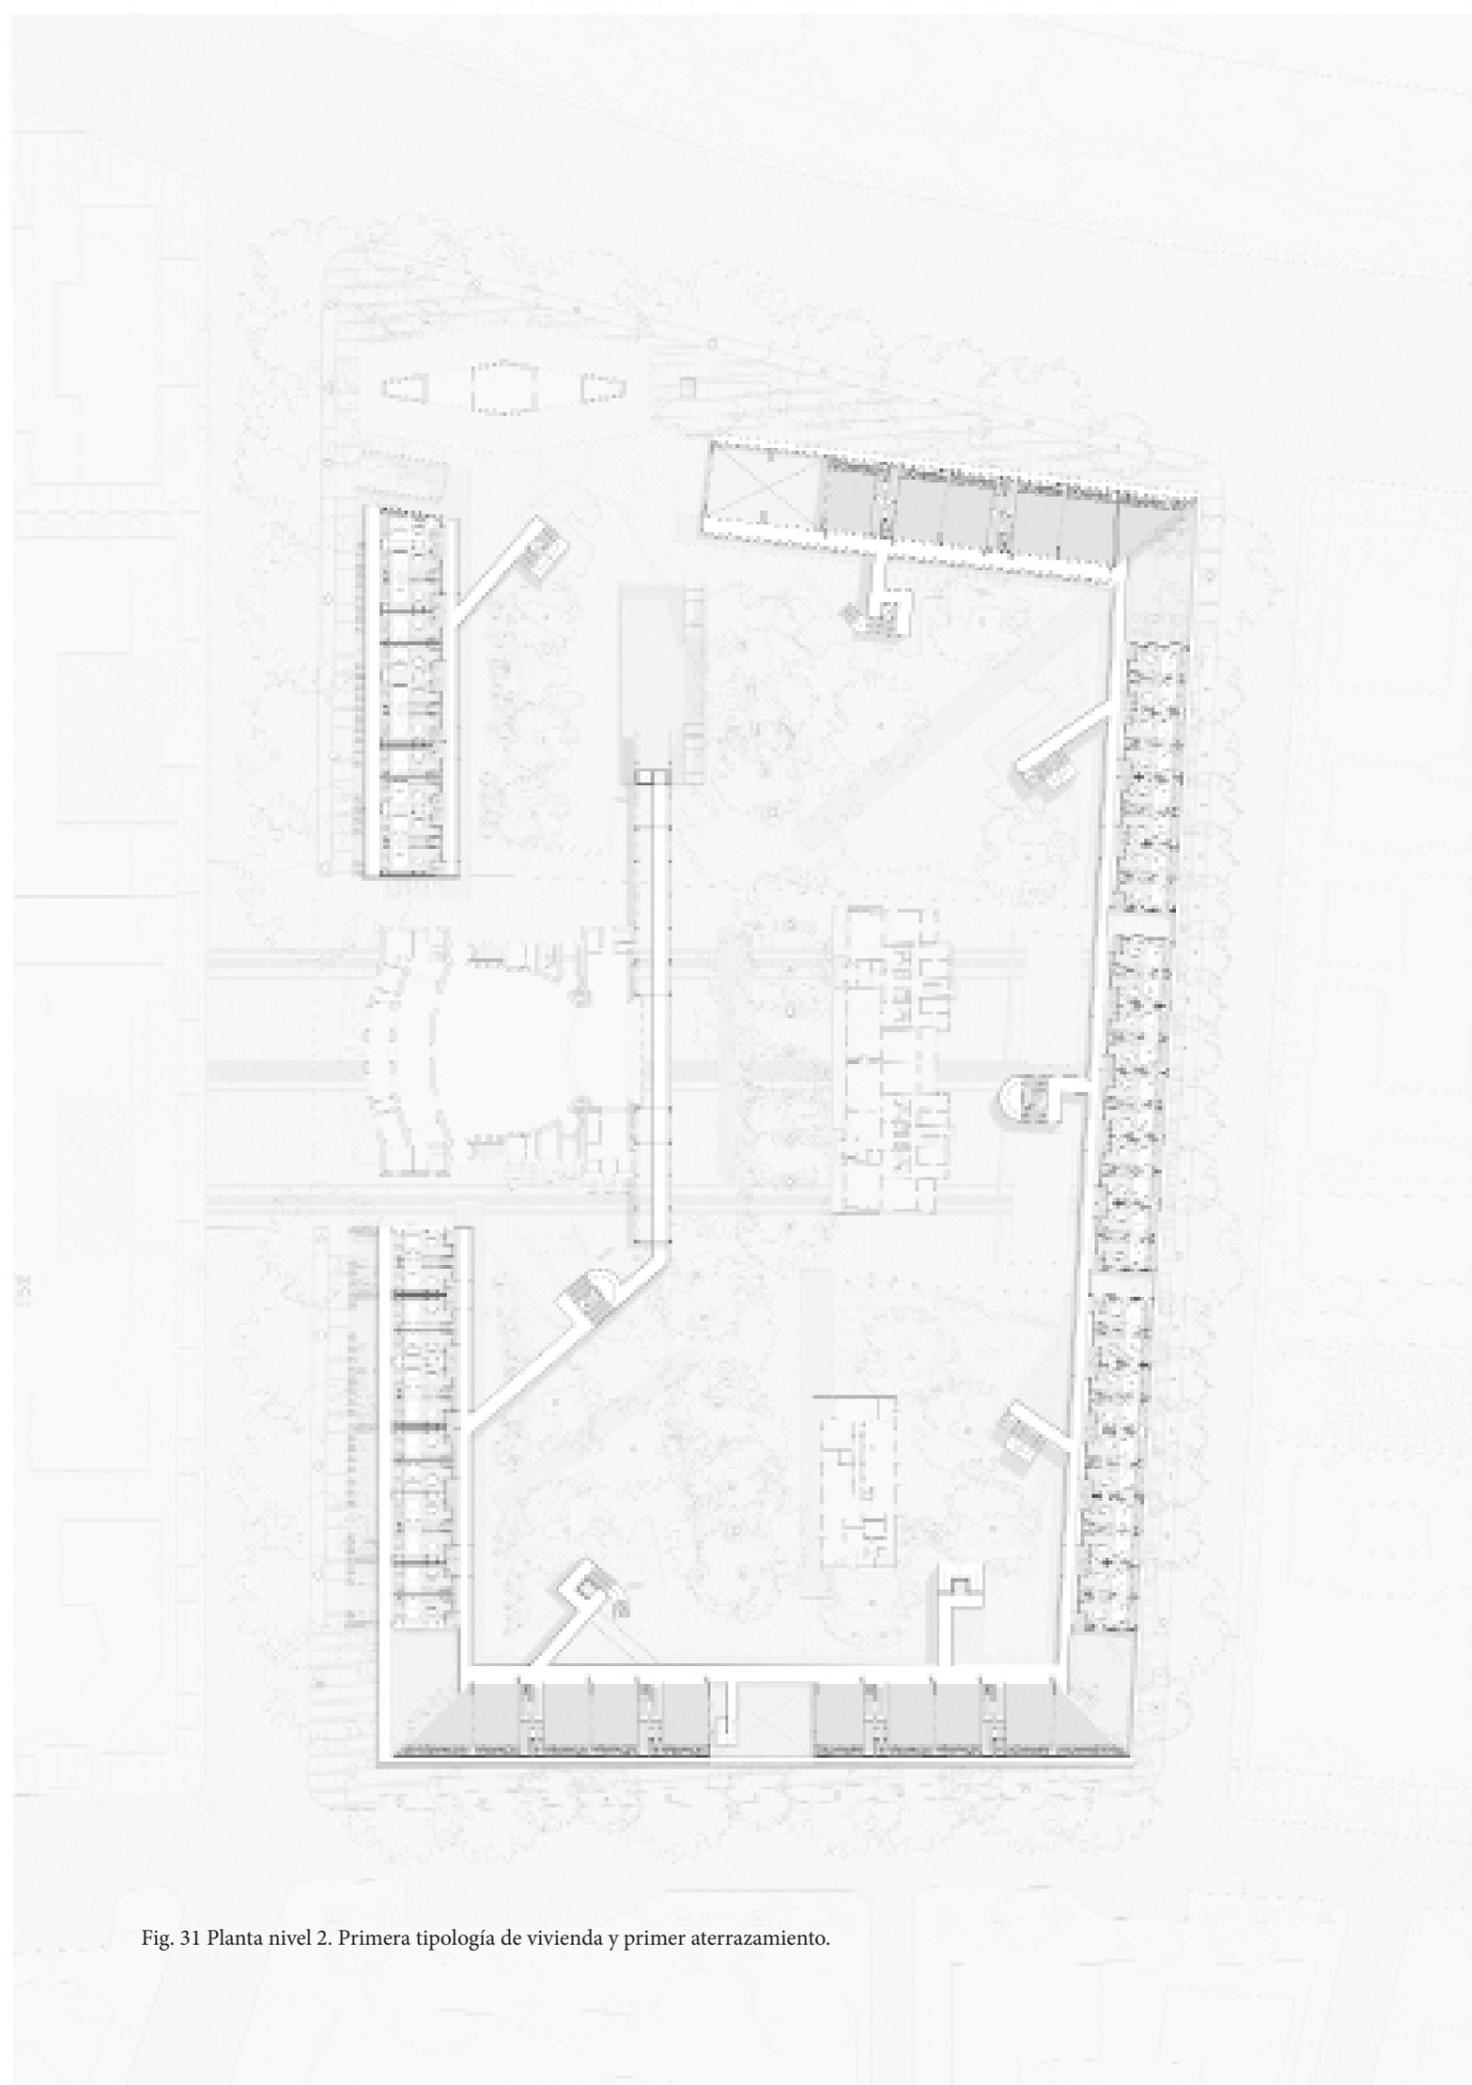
Planta nivel 2. Primera tipología de vivienda y primer aterrazamiento.
